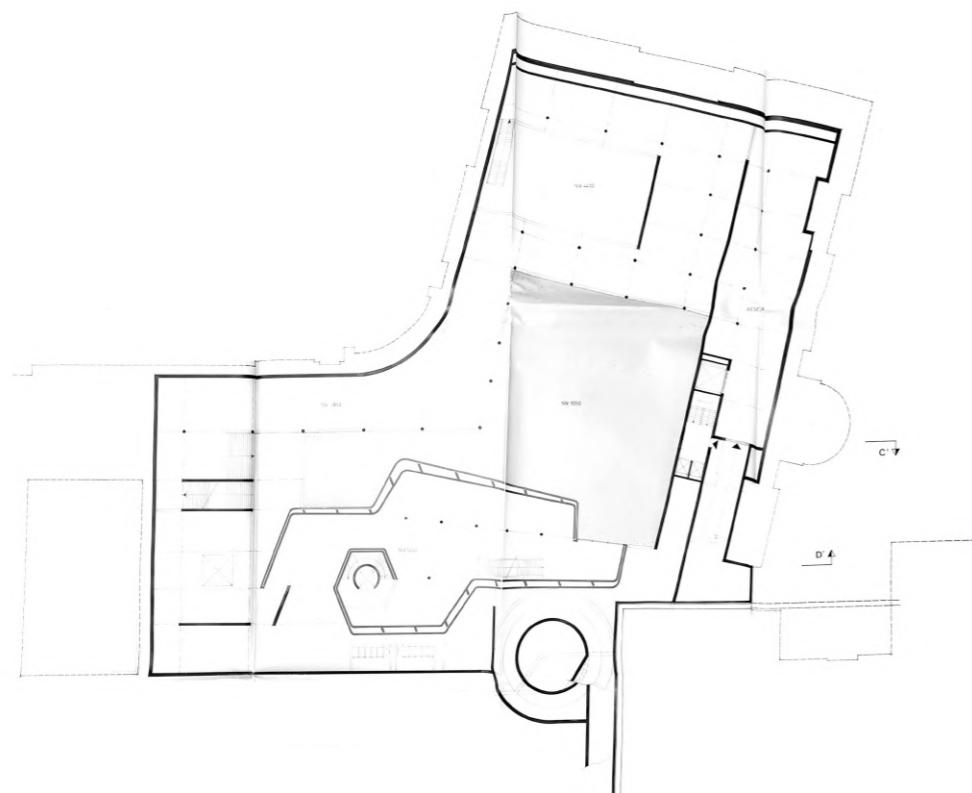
Plan R-2, 6^{ème} esquisse v3.
